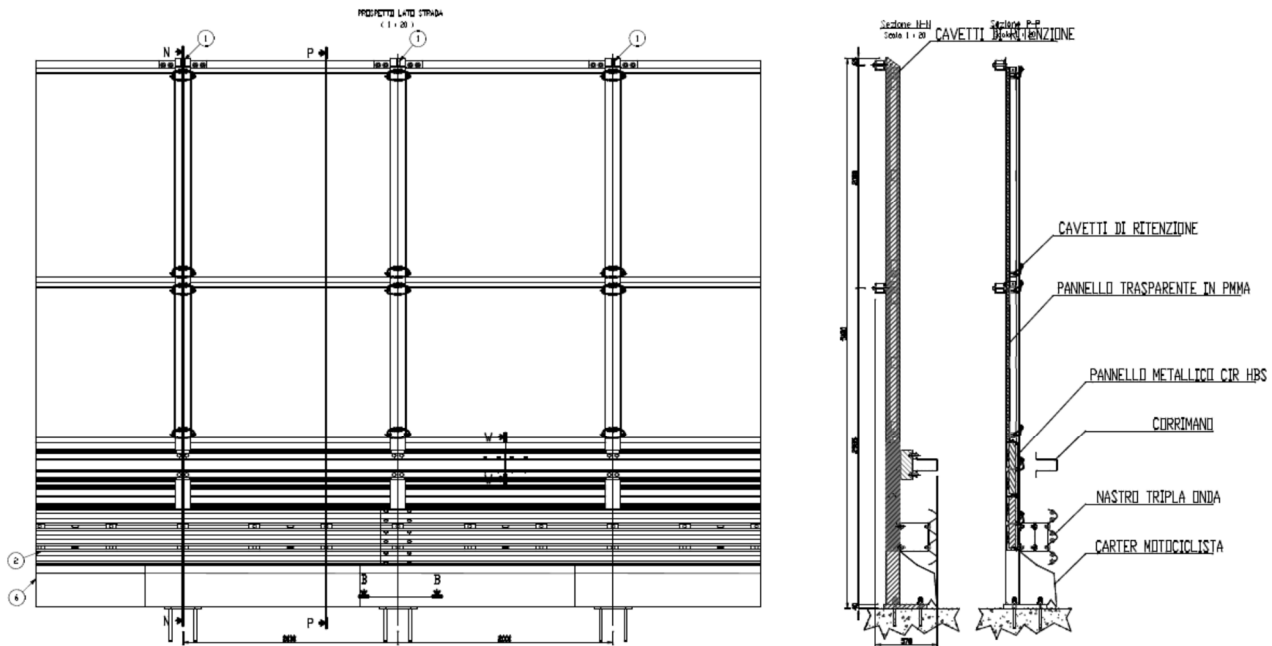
Prospetto lato strada e sezione della barriera integrata prevista in progetto
